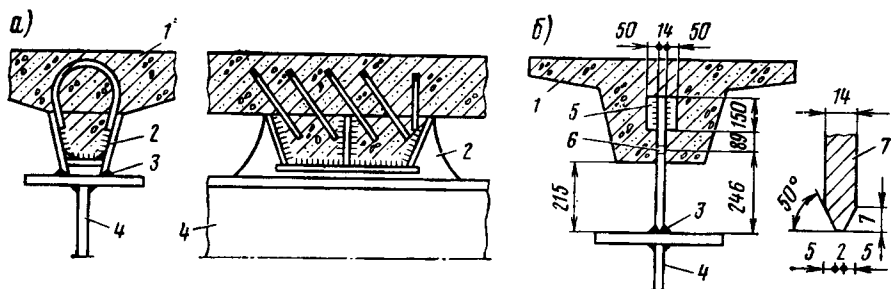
Конструкции объединения сборных железобетонных плит со стальными балками:
